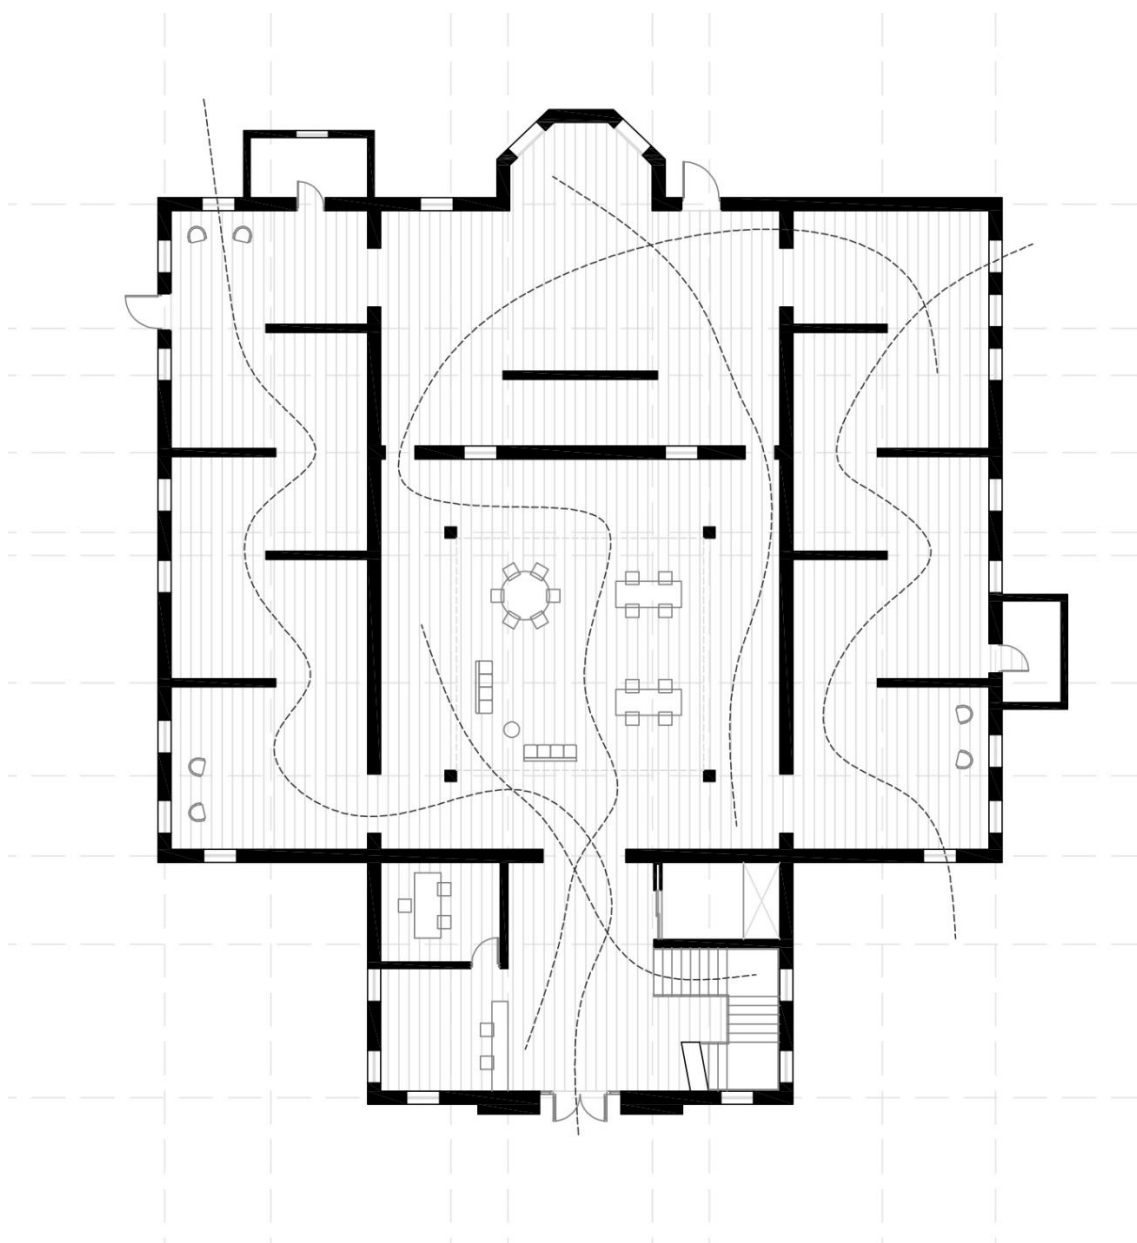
Planta baixa - Projecte (Autoria pròpia)
